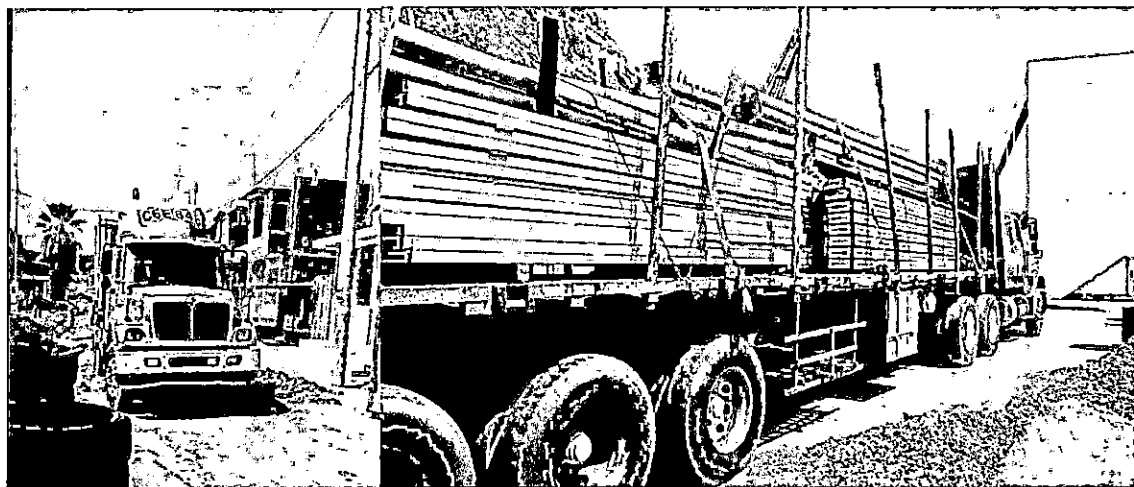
Ingreso de la estructura metálica en el DPA - Yacila.
